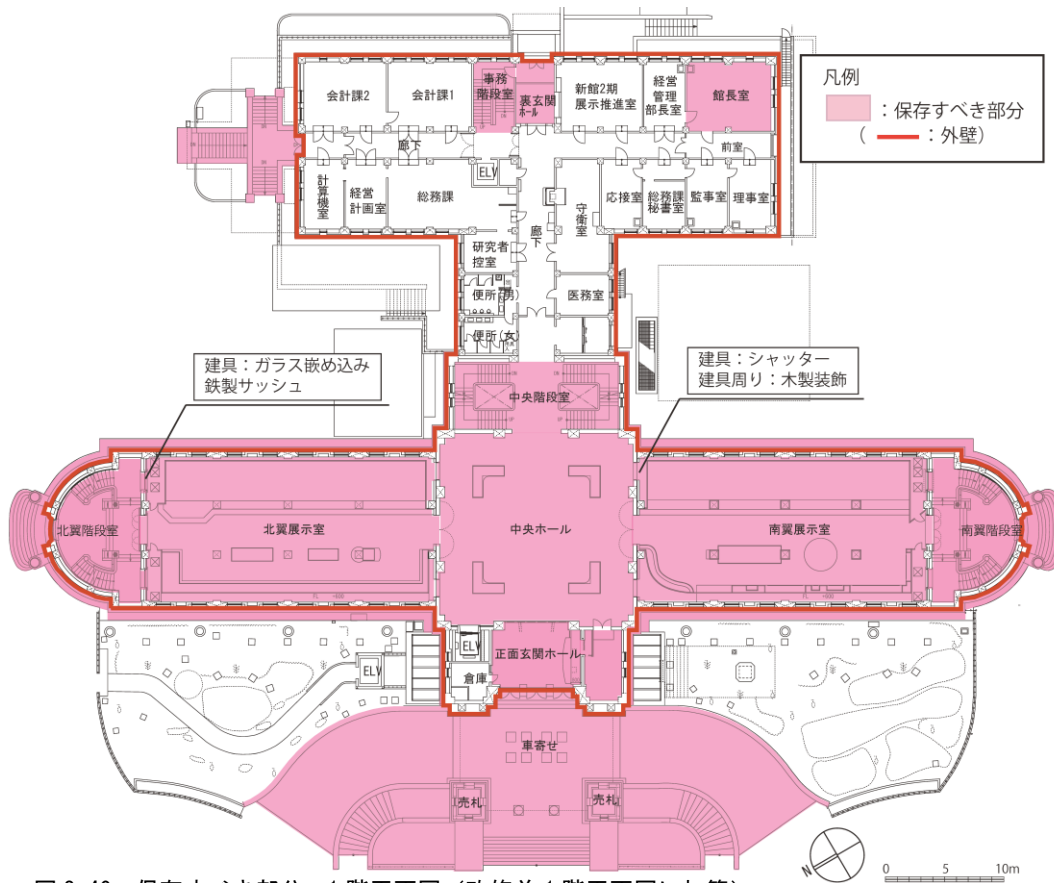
保存すべき部分 1階平面図（改修前1階平面図に加筆）
